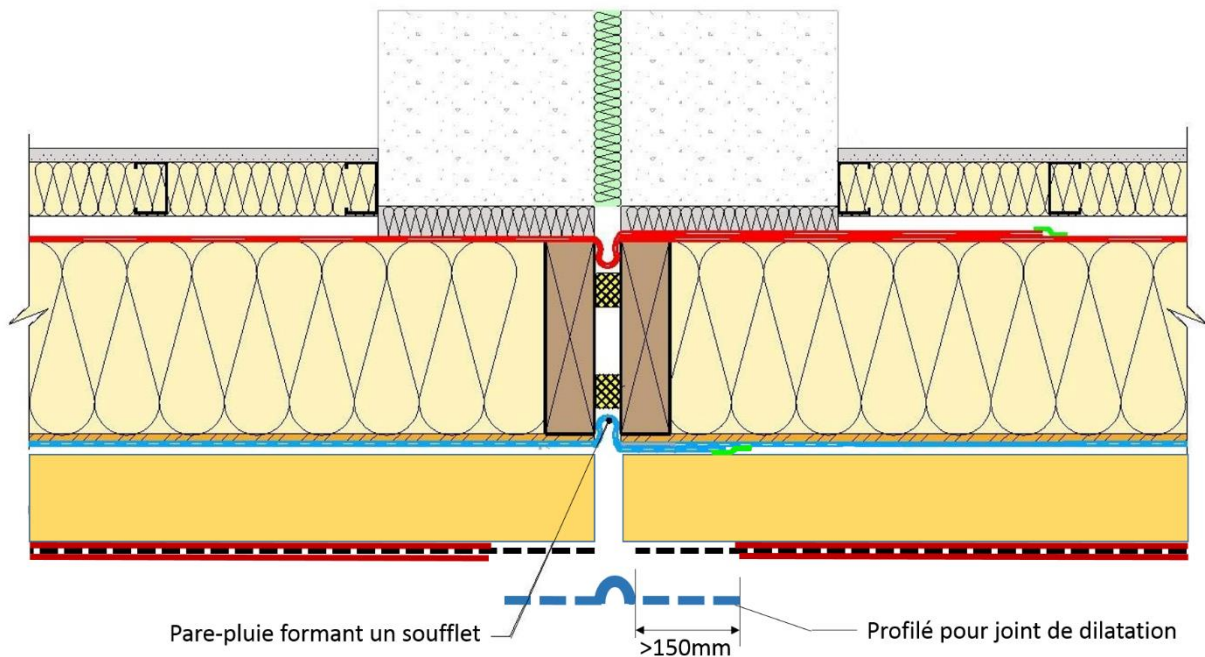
Gestion d'un joint de dilatation (Ee2) – coupe horizontale
